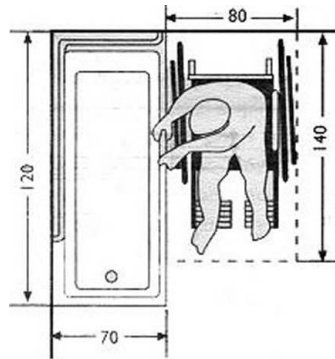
Vista en planta de maniobra en la ducha o bañera.
